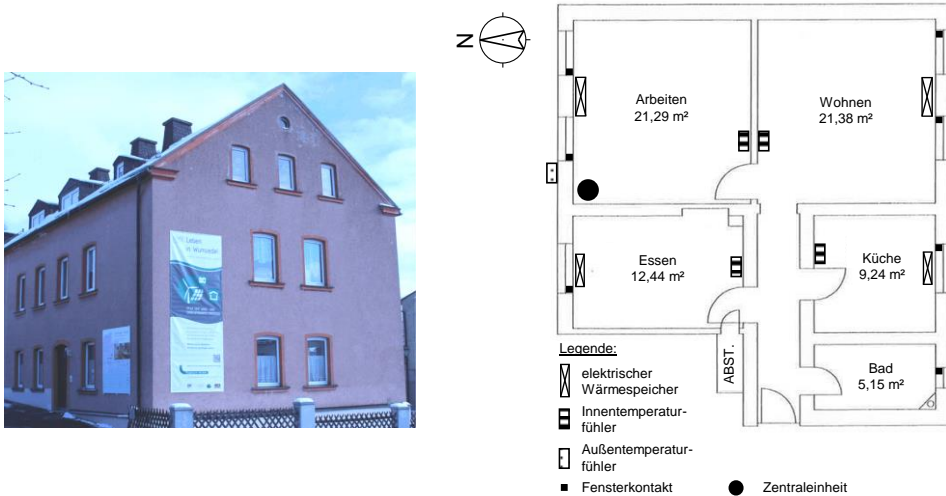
Außenansicht und Grundriss der Versuchswohnung
